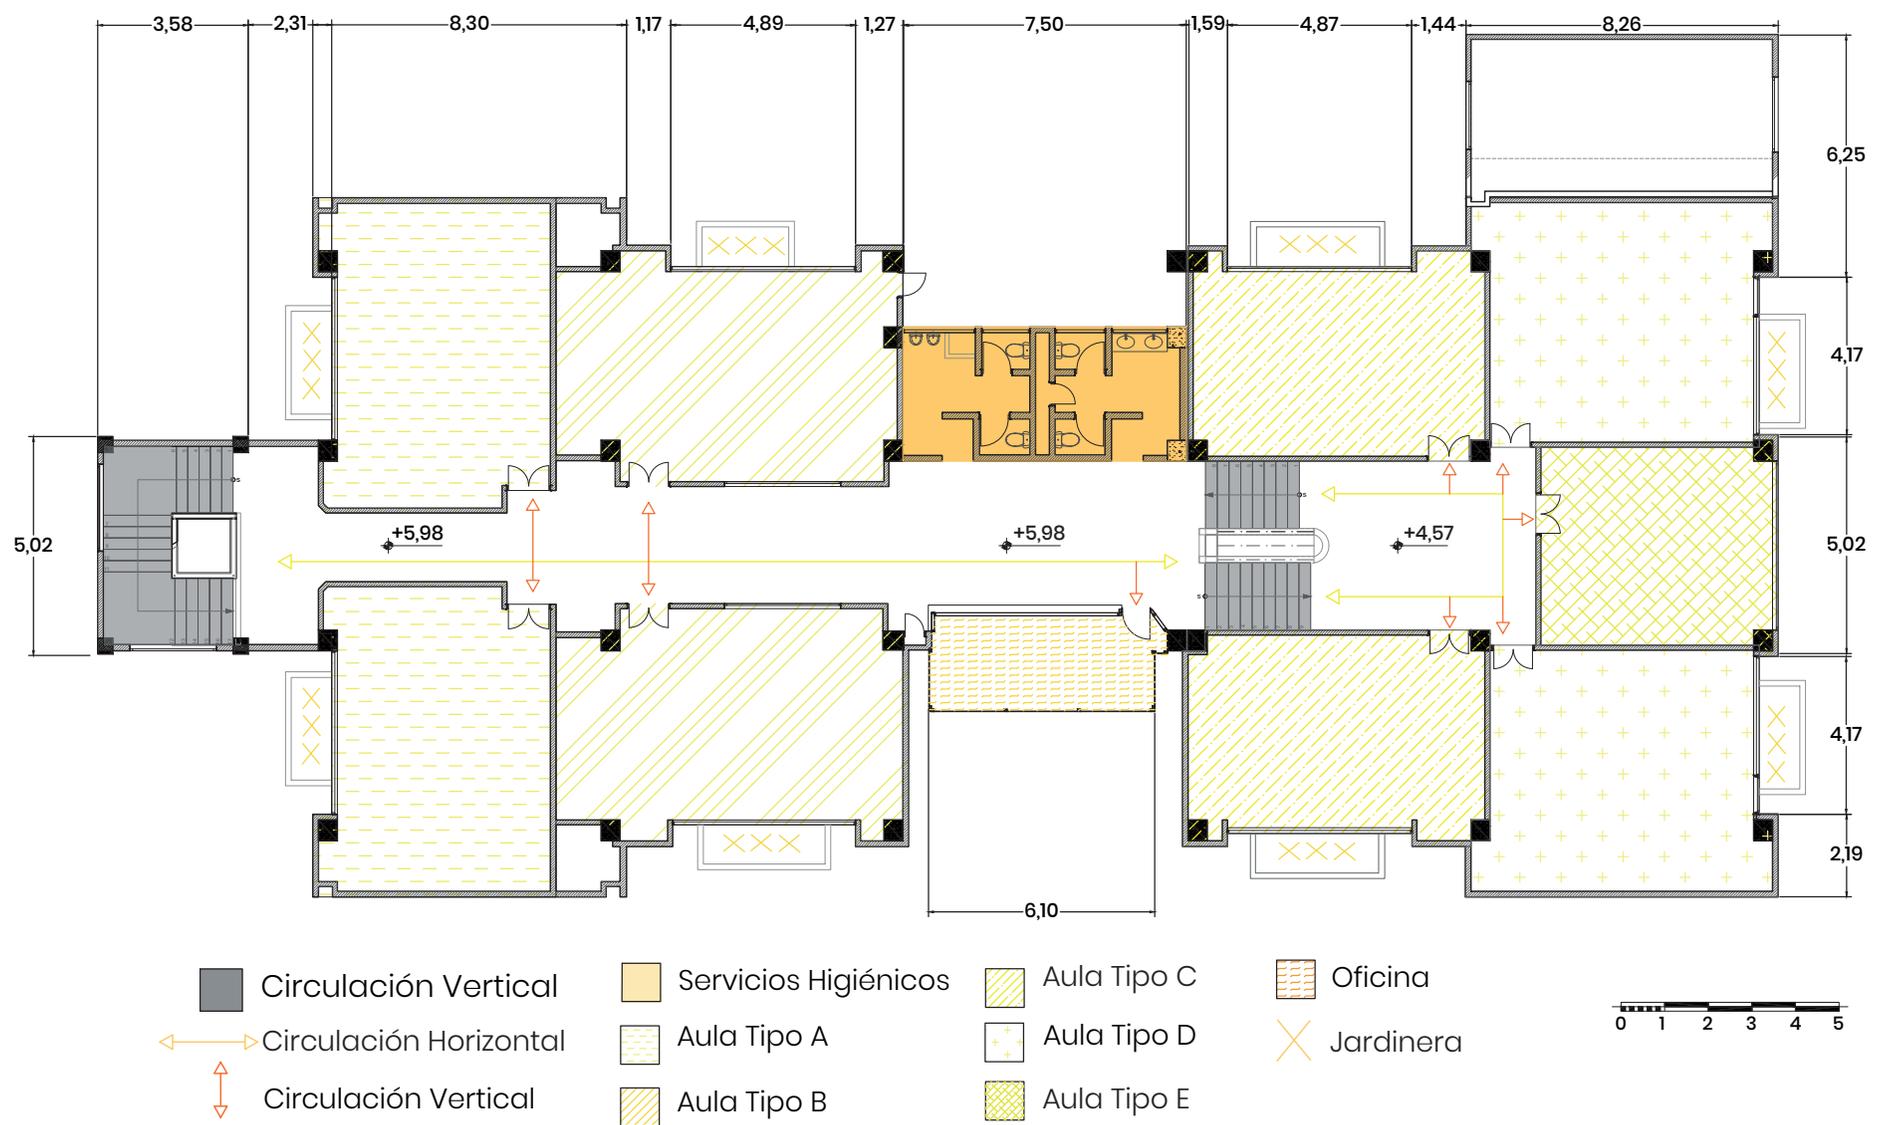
Zonificación Tercera y Cuarta Planta Alta Bloque "E1".
